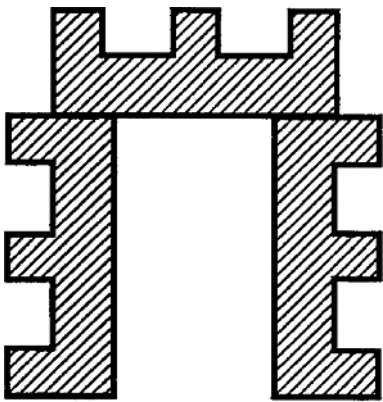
Schematisierter Grundriss eines zweigeschossigen Vielraumgebäudes in Pavillonbauweise. Das Bauwerk besteht aus drei unter sich jeweils gleichen Teilen, die in drei Bauabschnitten erstellt wurden. Die Länge der Gebäudeteile beträgt ca. 70 m.
